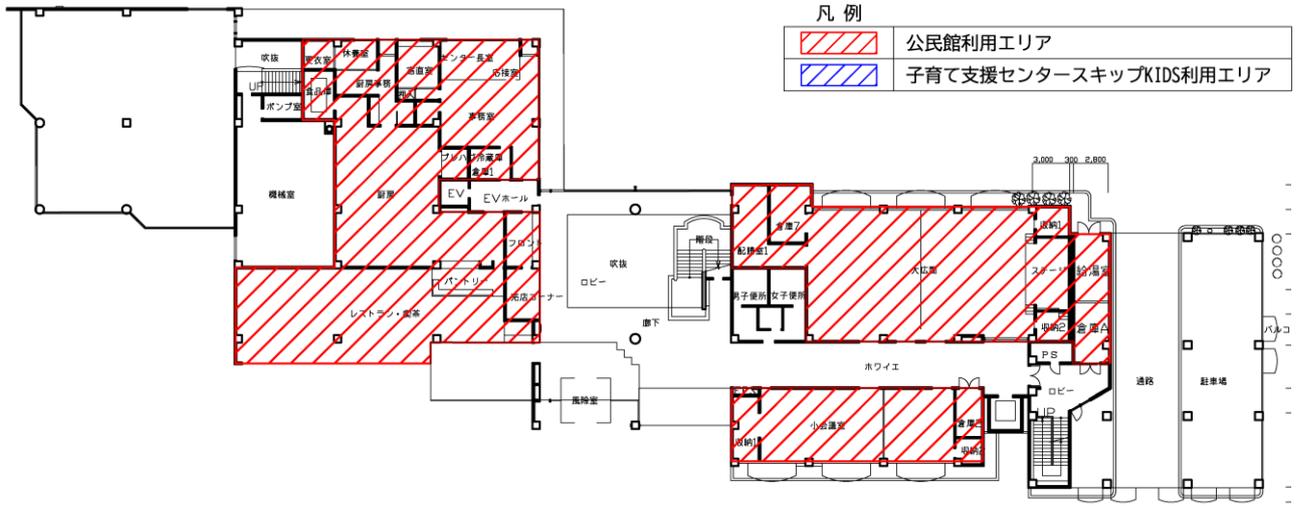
サンヒル柏原 機能位置図 (案) 1階平面図
